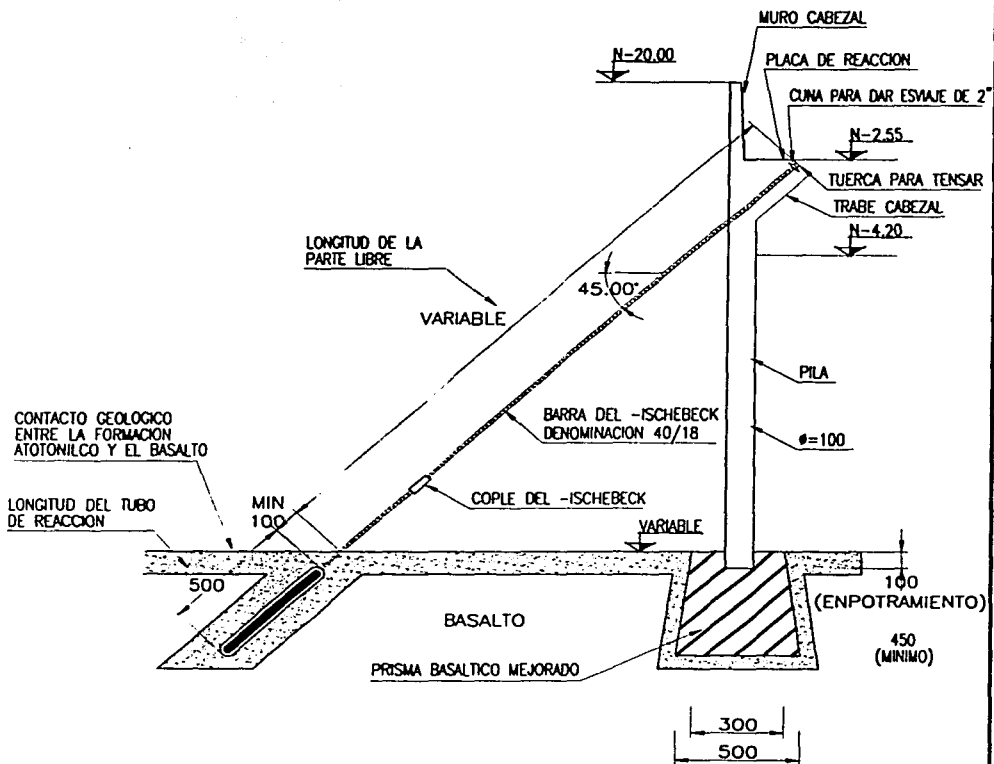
CORTE ESQUEMATICO DE LAS PILAS CONFINANTES.
